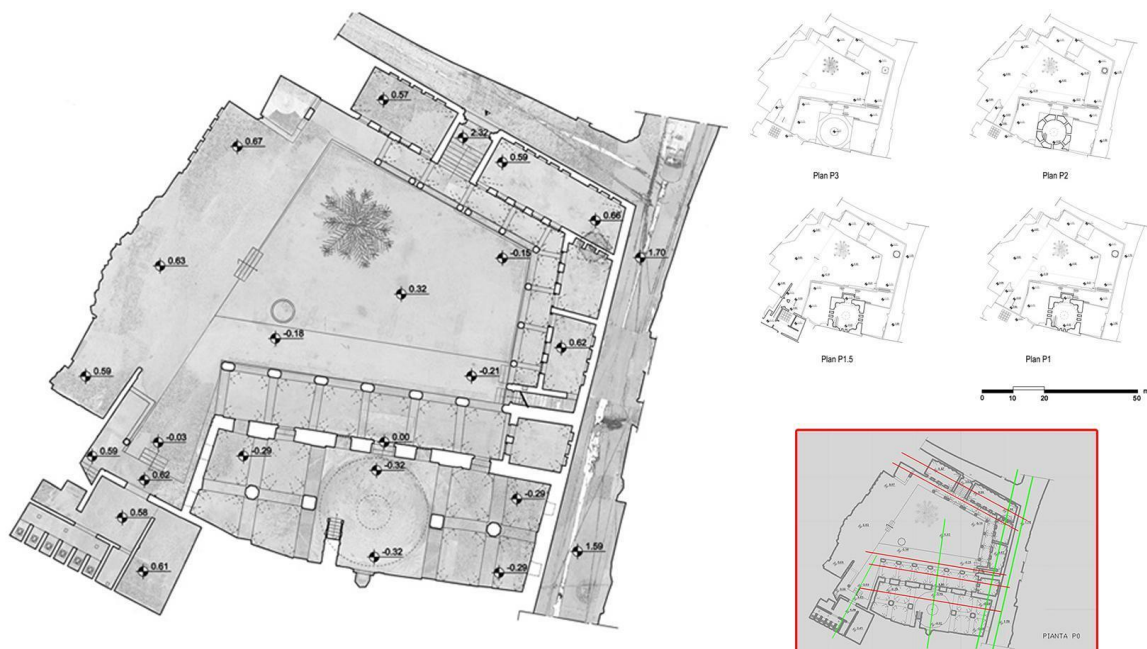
Pianta a P0 stabilito (in grande). Sulla destra elaborazioni della pianta ad altre quote. In basso a destra elenco dei prospetti e sezioni
